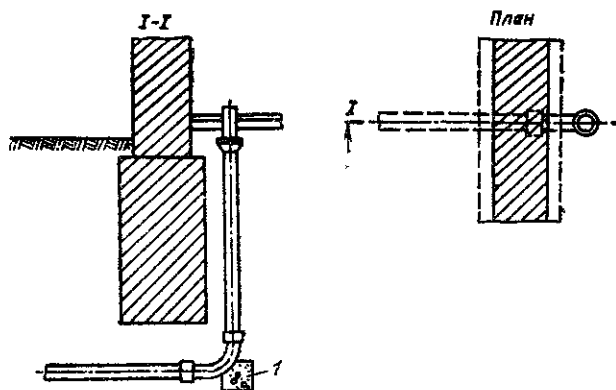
Ввод водопровода при ленточном фундаменте
